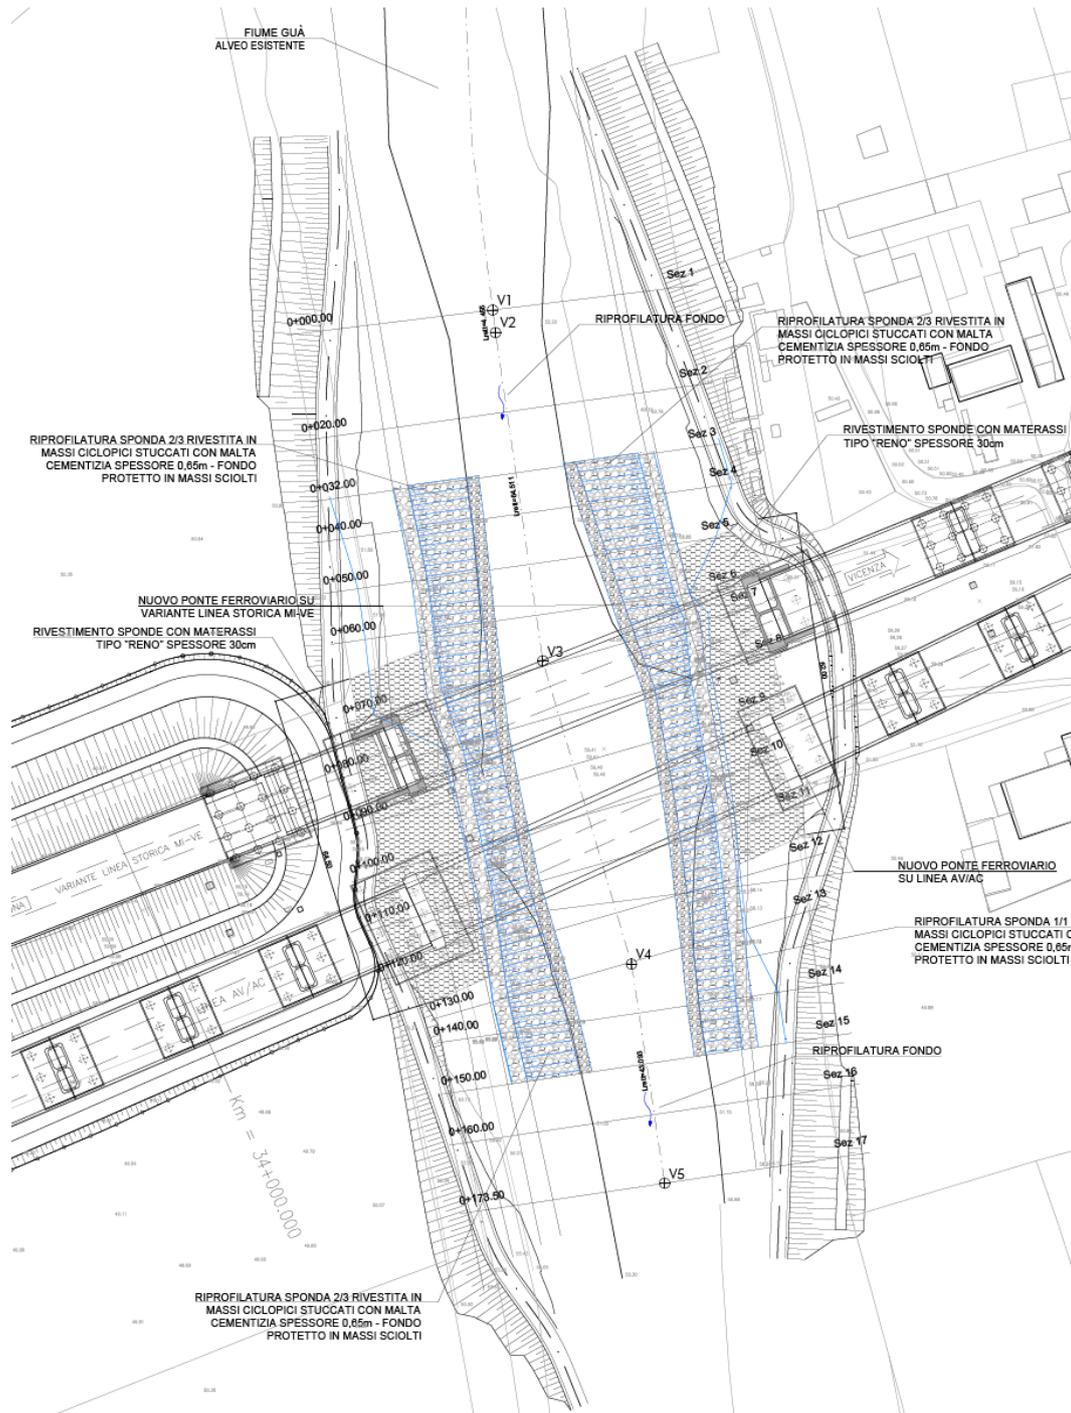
Estratto dalla tavola stato di progetto sistemazione Fiume Guà
